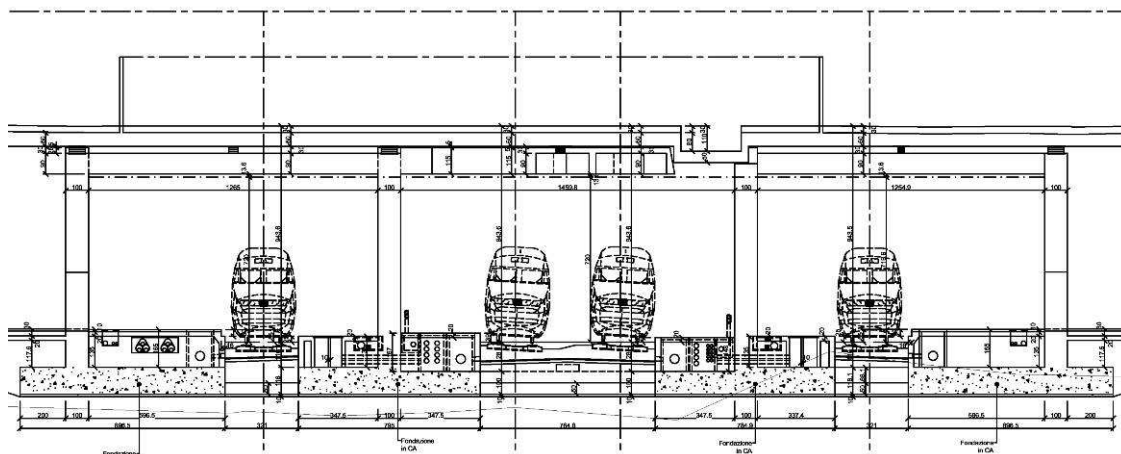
sezione trasversale travi rovesce al di sotto dei setti della stazione.
